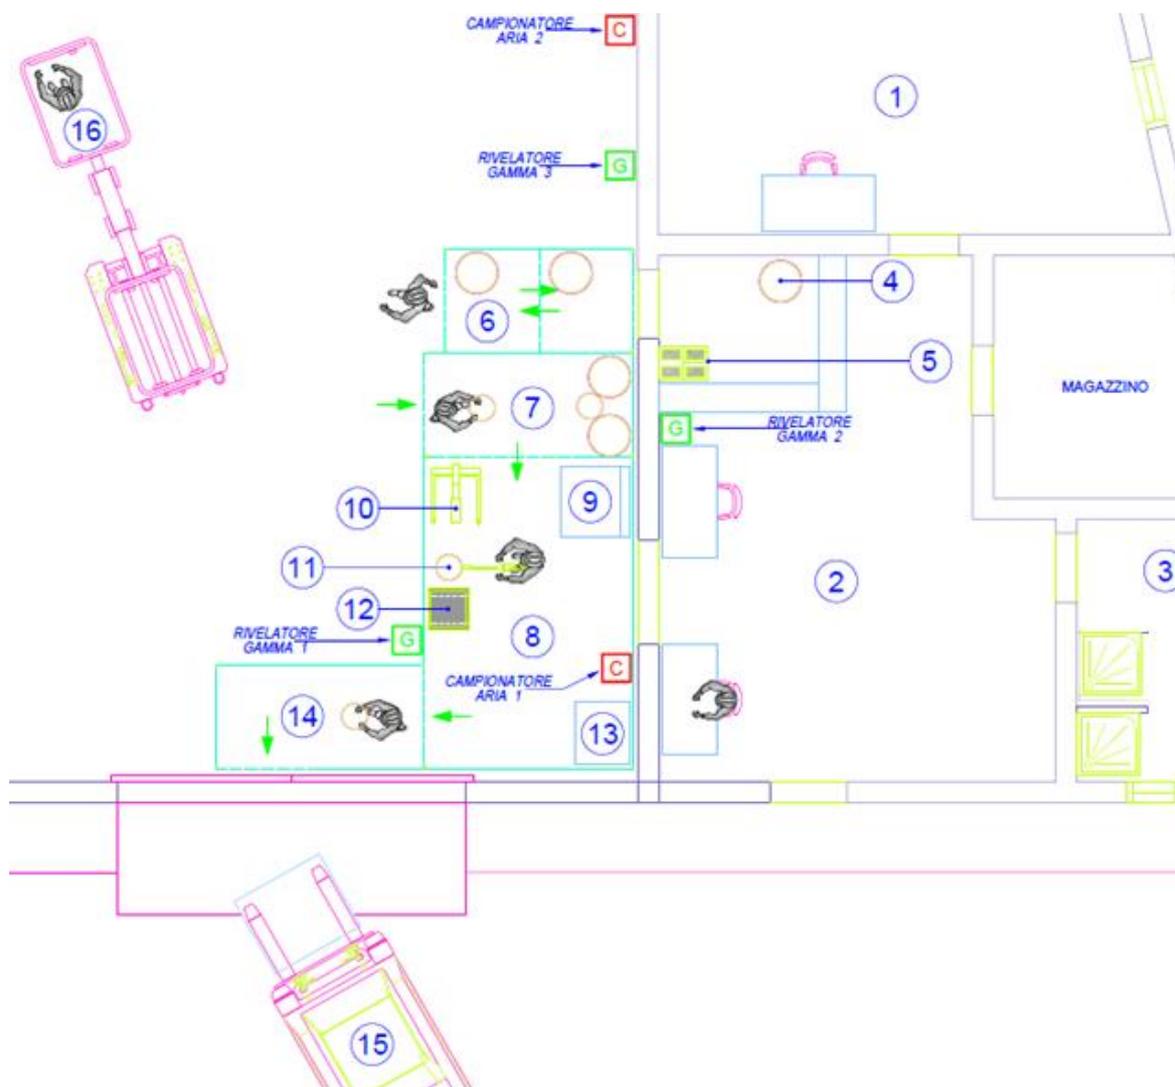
Planimetria con indicazione delle aree di lavoro *predisposte* e da utilizzare durante le attività di bonifica
